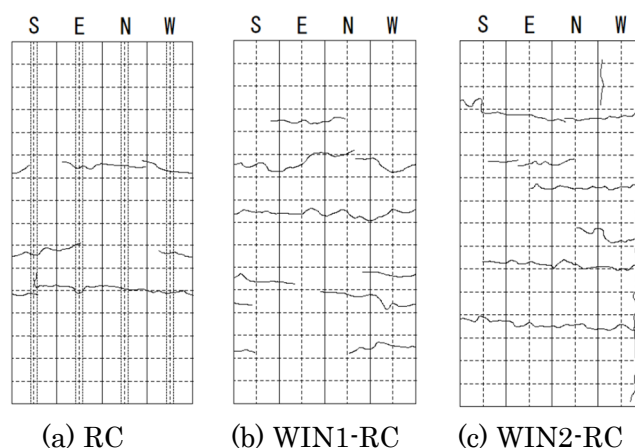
ひび割れ状況 (58kN 載荷時)
